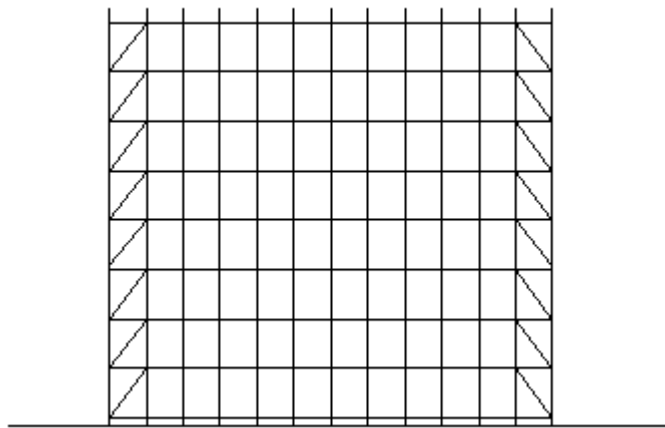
碗扣式模板支架专用斜杆布置平面示意图
